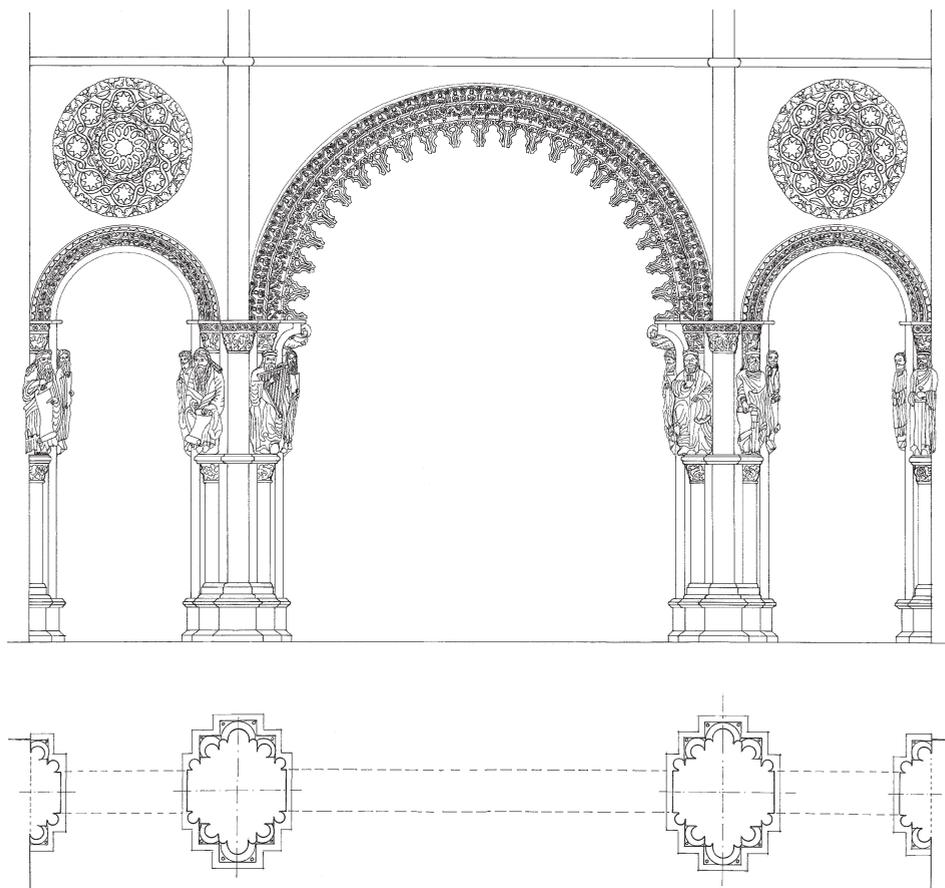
Reconstrucción hipotética (planta y alzado) de la fachada del Pórtico de la Gloria según Ramón Otero Túñez y José Ramón Soraluce Blond. © José Ramón Soraluce Blond.
